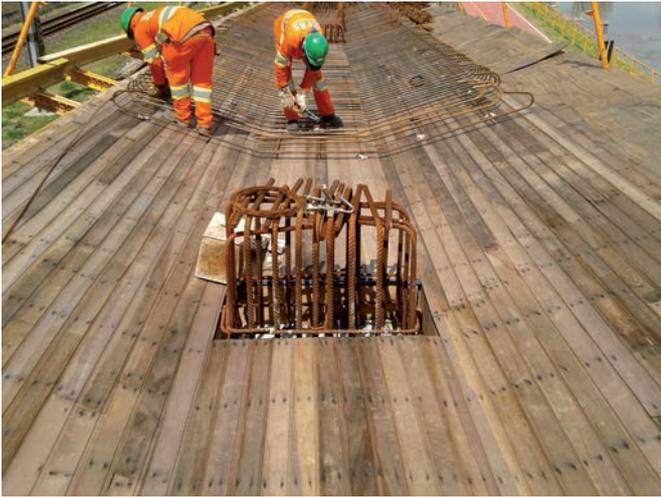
Herstellung Rampenbauwerk entlang Radweg vor dem Rio Pinheiros
